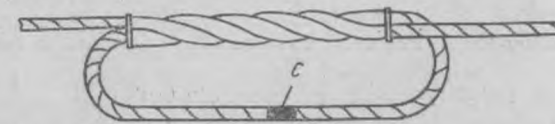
Соединение проводов соединителем и термитной сваркой
